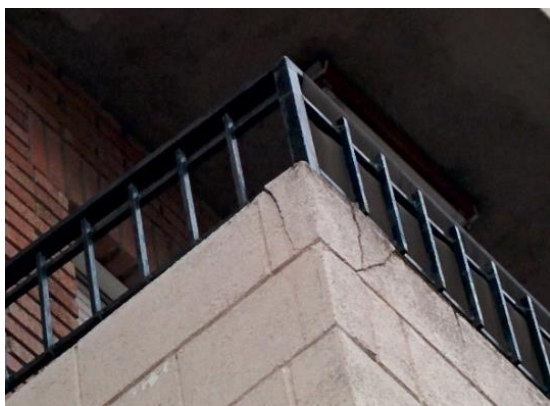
Corrosión por inmersión o par galvánico en Camino Real Nº 26. Fuente: Autor
